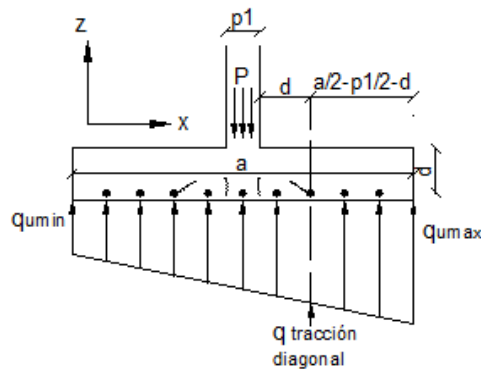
8 Sección crítica y distribución de presiones para determinar el cortante por tracción diagonal para zapatas cargadas excéntricamente.
